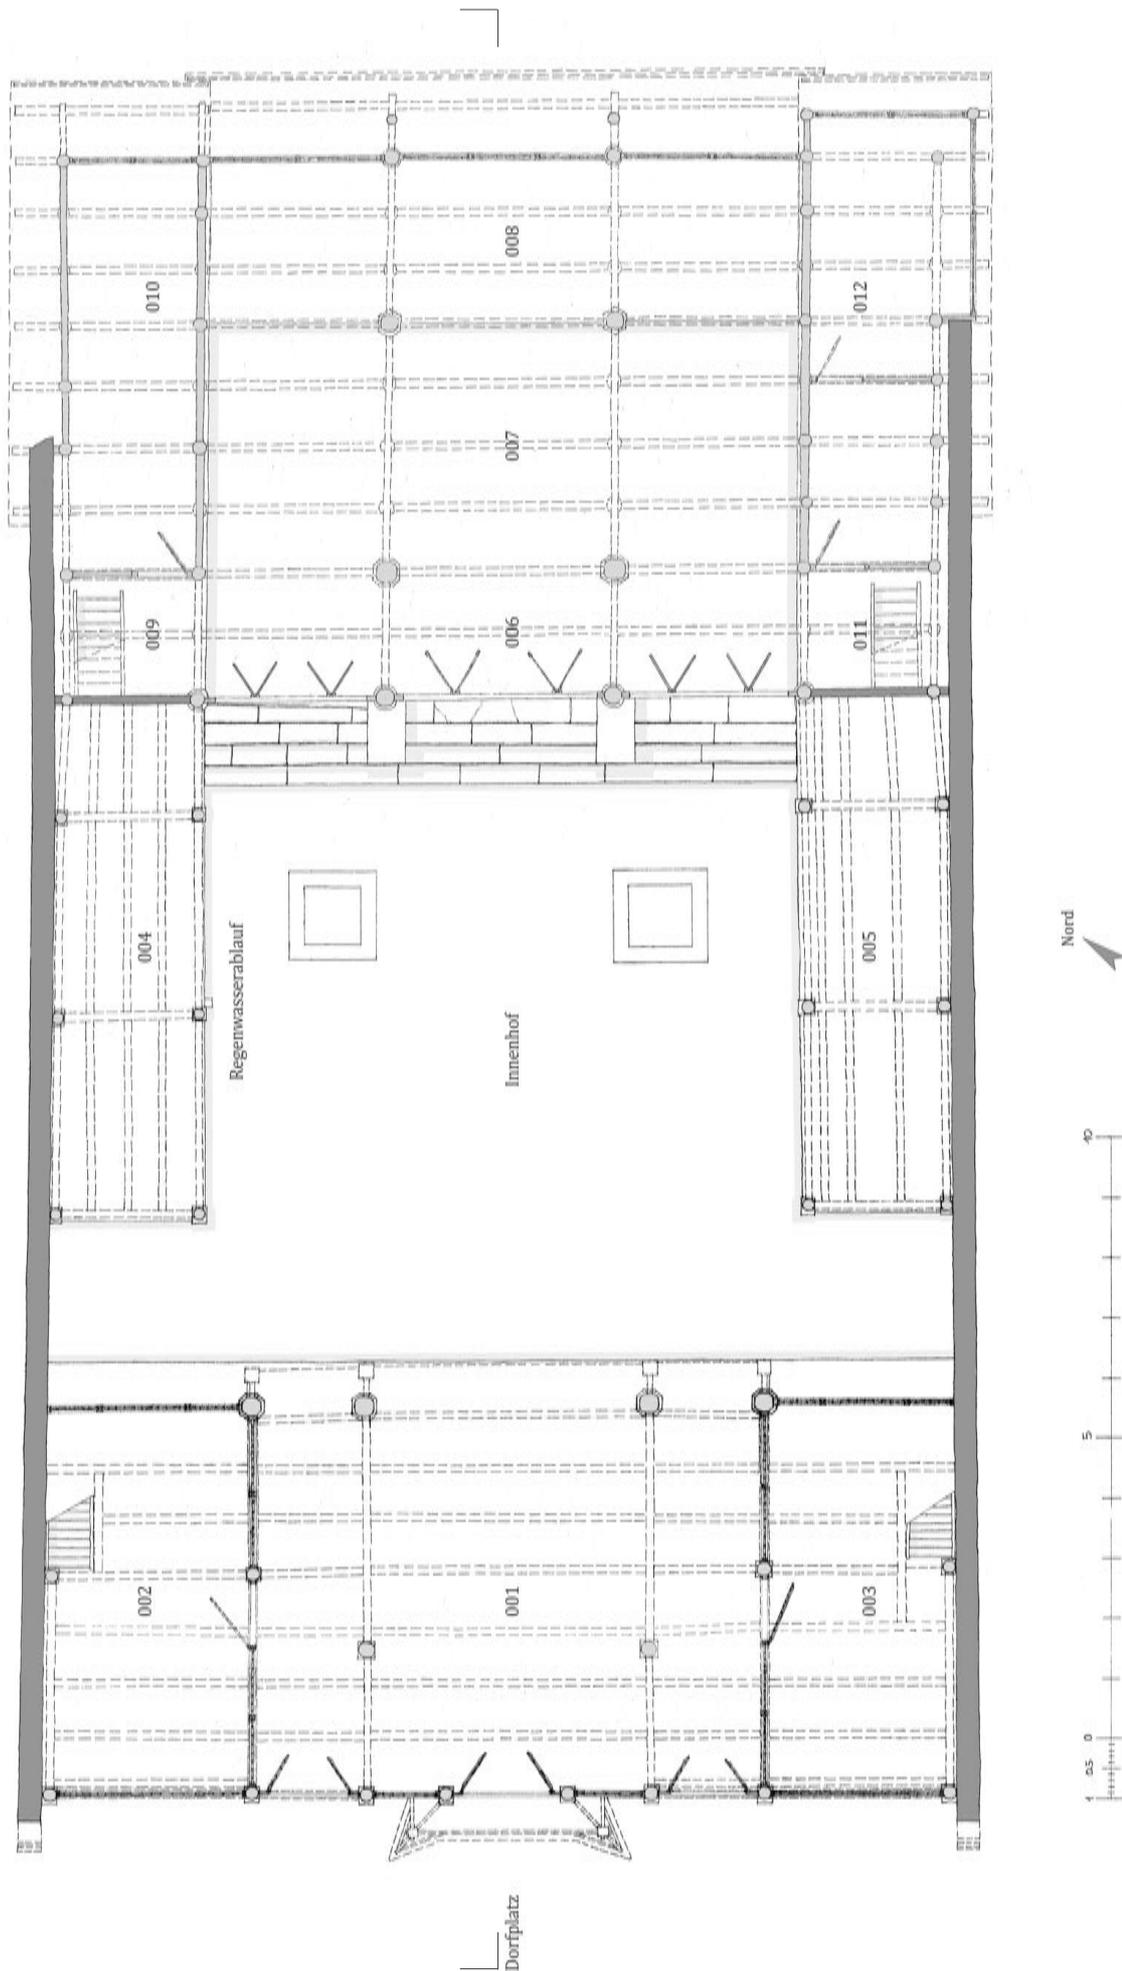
Grundriss Tempel Wanshou (EG), M 1:125
